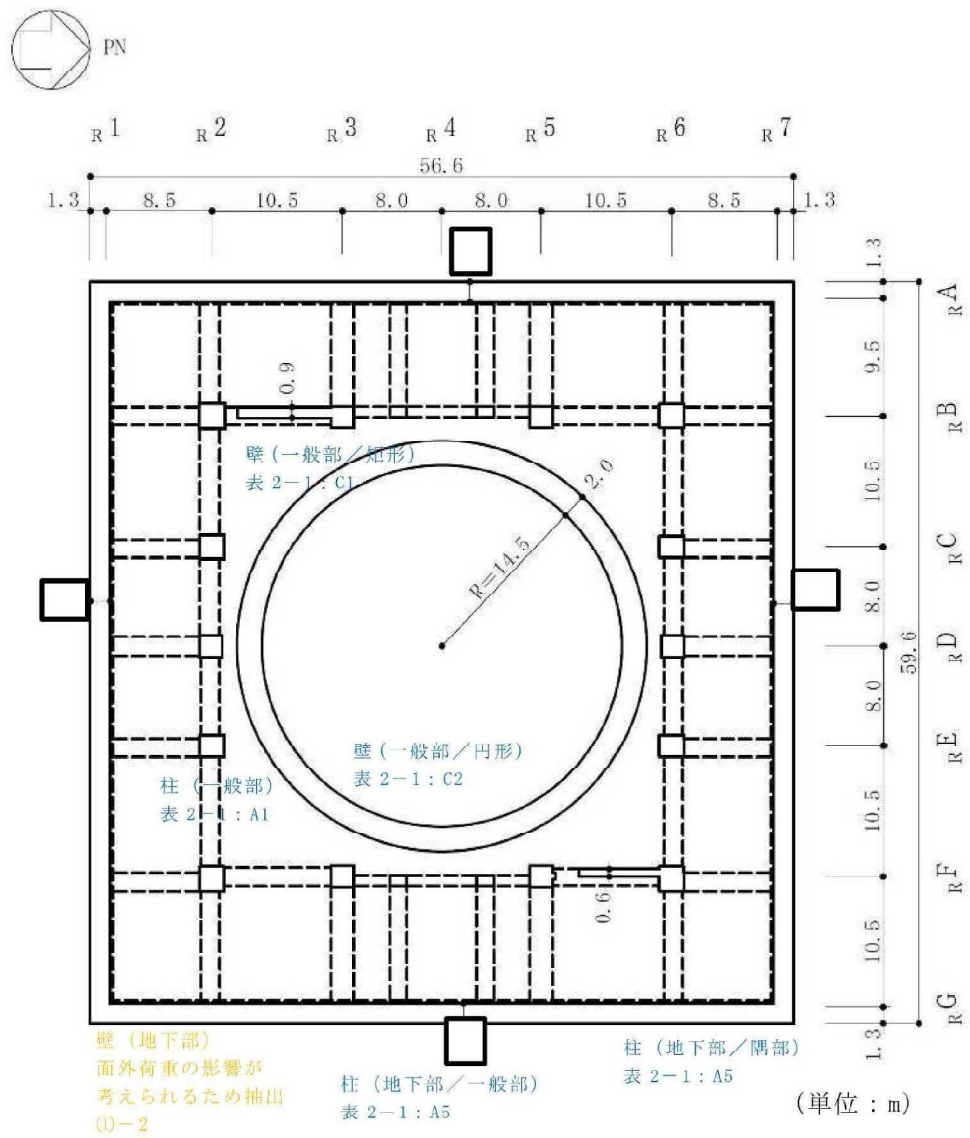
原子炉建屋の概略平面図 (B2F, T.M.S.L. -1.7m) (2/8)
